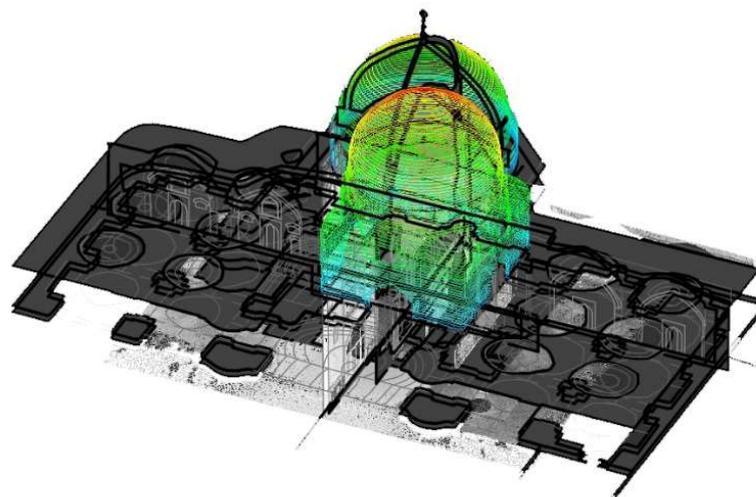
AutoCAD – Gesamtmodell: Grundrisse, Schnitte, Orthofotos und Projektionen
